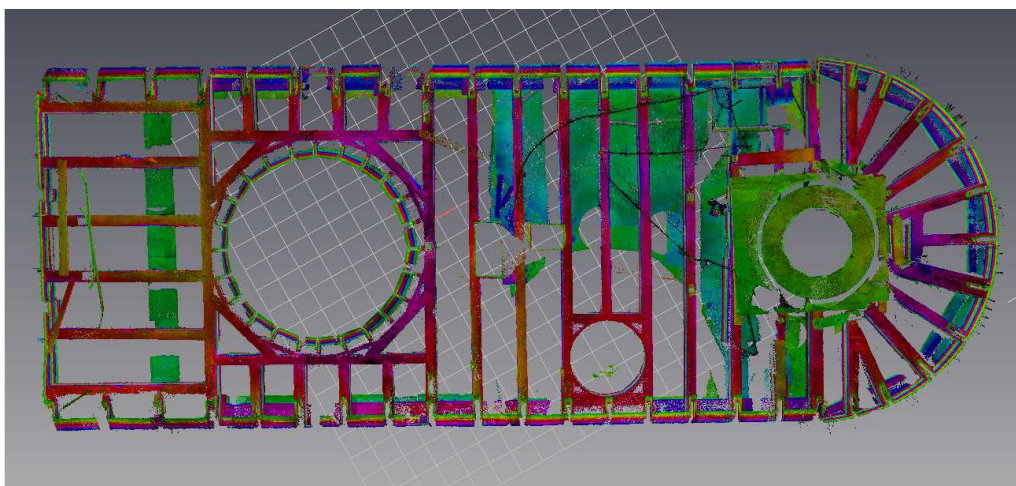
Widoczne oparcie jętki na konstrukcji plafonu – wynik skanowania 3D.
